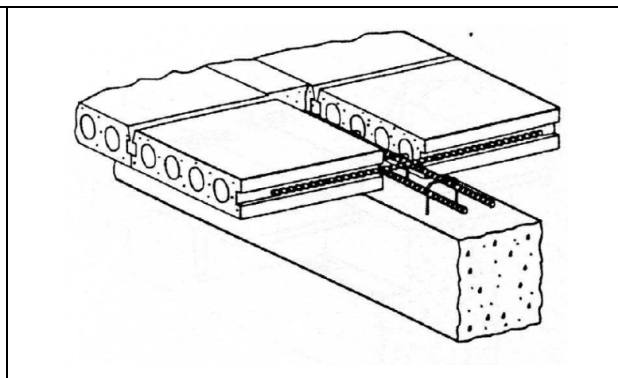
Ligação de lajes alveolares através de amarração, em paralelo com a laje (PCI)
